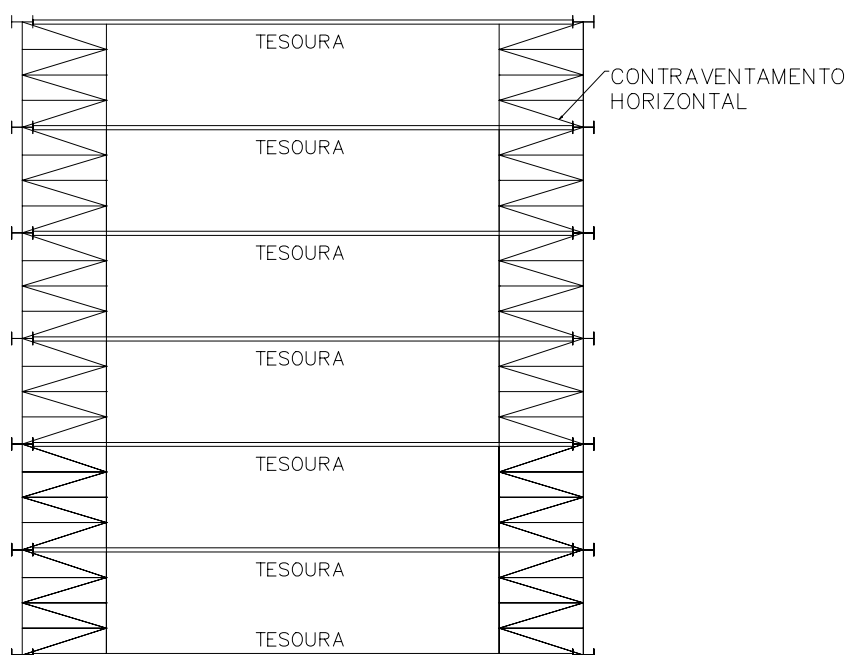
Planta mostrando o contraventamento horizontal.
